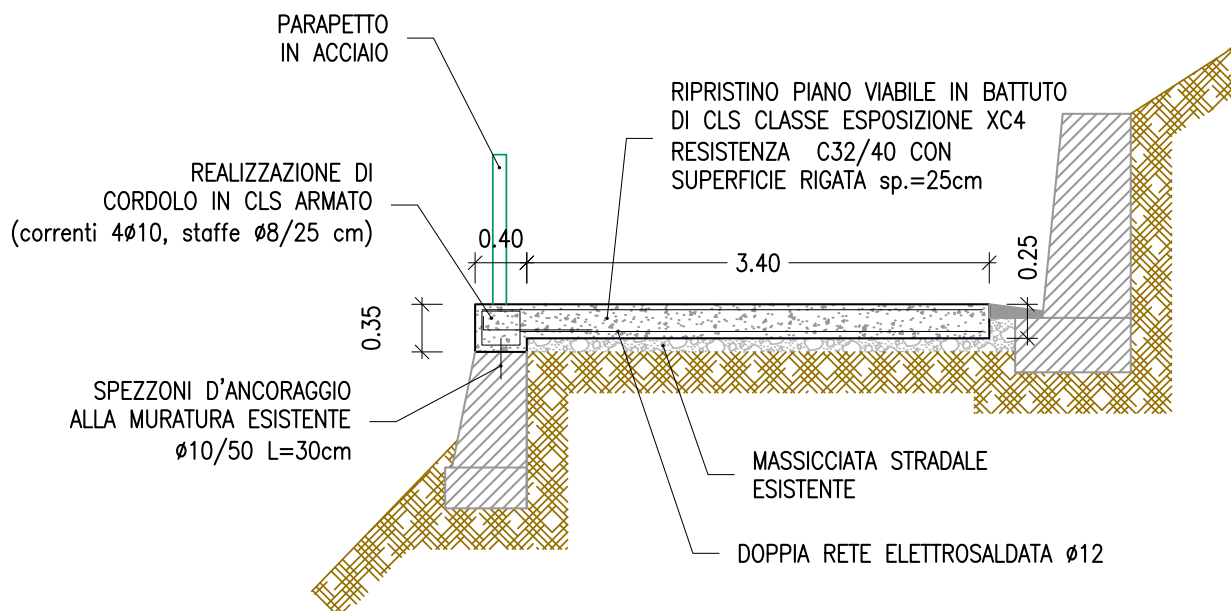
Sezione tipo opera pavimentazione strada in C.A.
